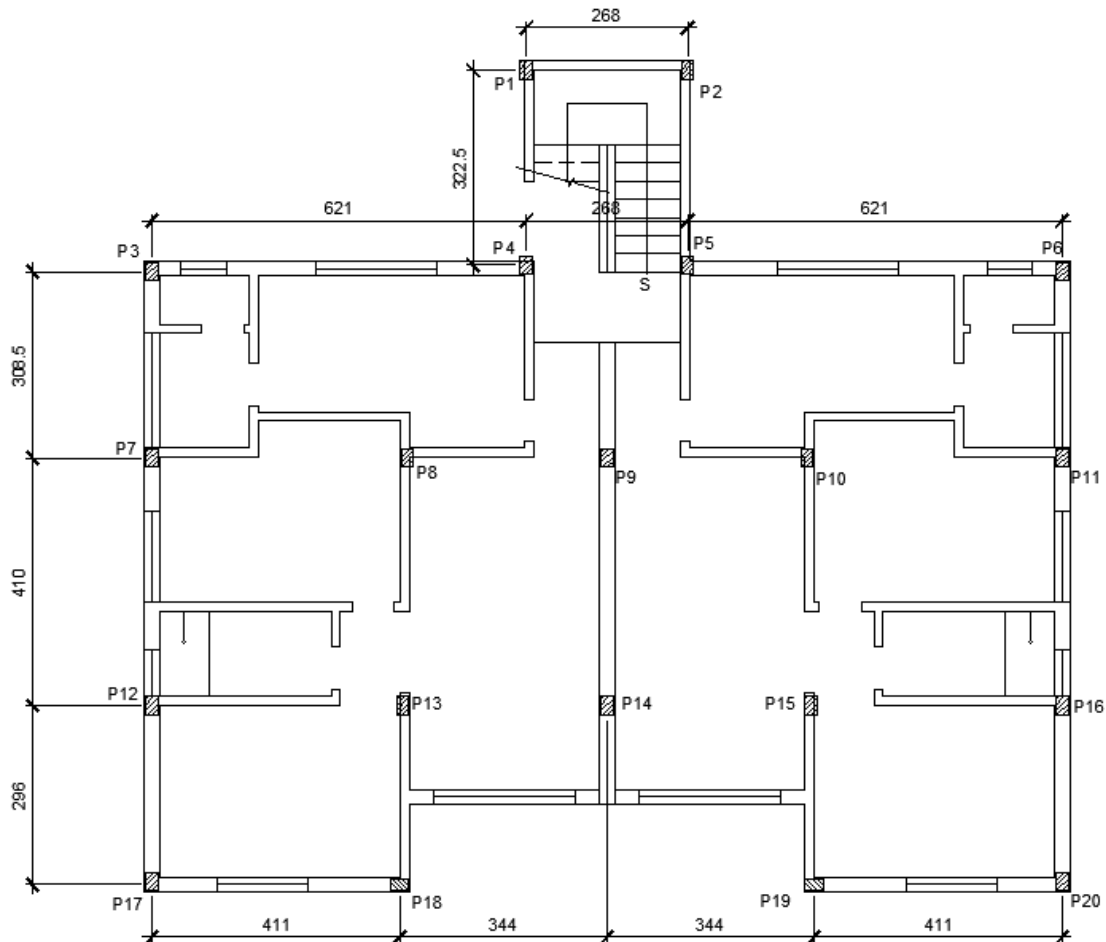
Locação dos Pilares – Fundação, Primeiro, Segundo, Terceiro e Cobertura
